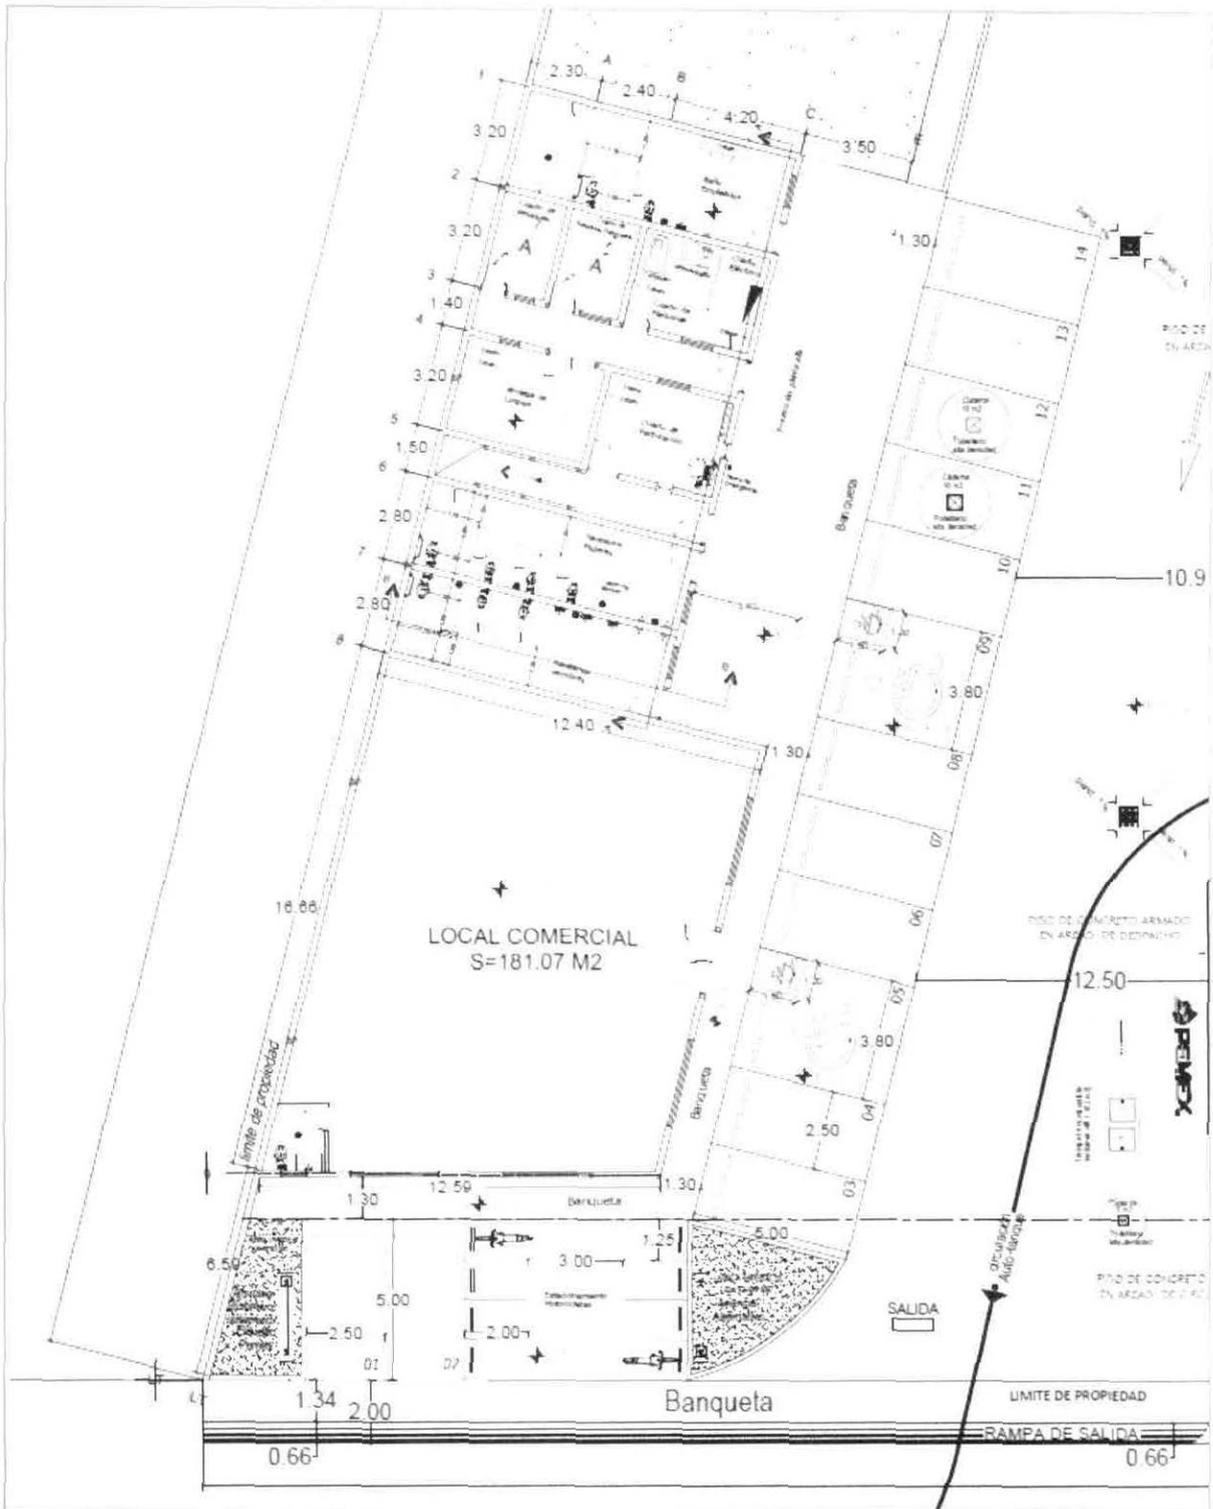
Plano general de construcción. Anteproyecto aprobado por PEMEX.
